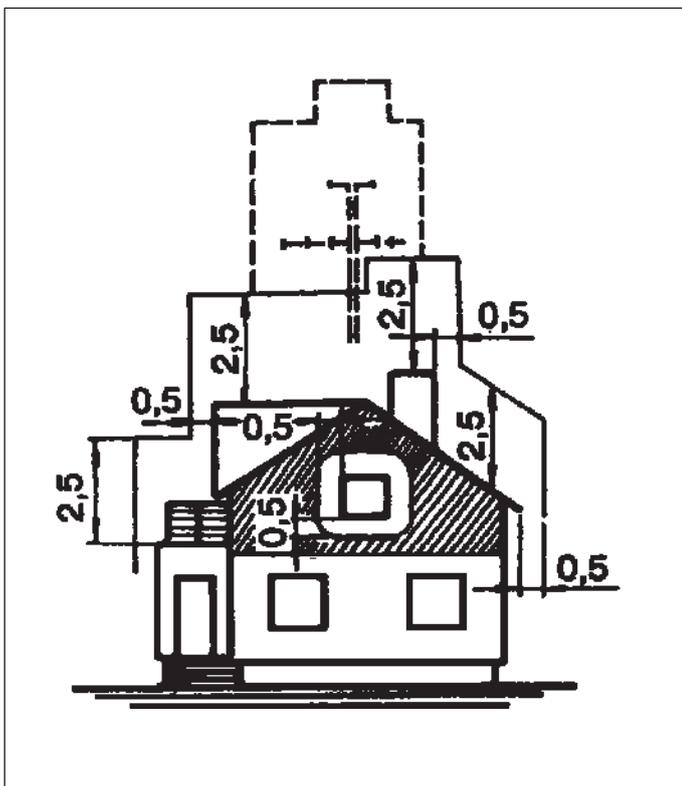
Расстояние от провода АМКА до здания, и участок стены, на котором допускается завершать провод.
